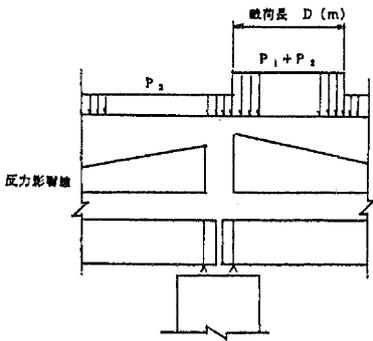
梁などを設計する場合の活荷重の載荷方法
